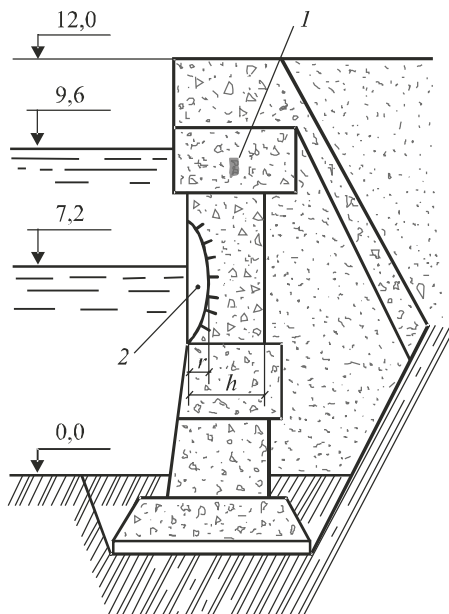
Схема бетонного причала для расчета предельно допустимой глубины повреждения конструкции
